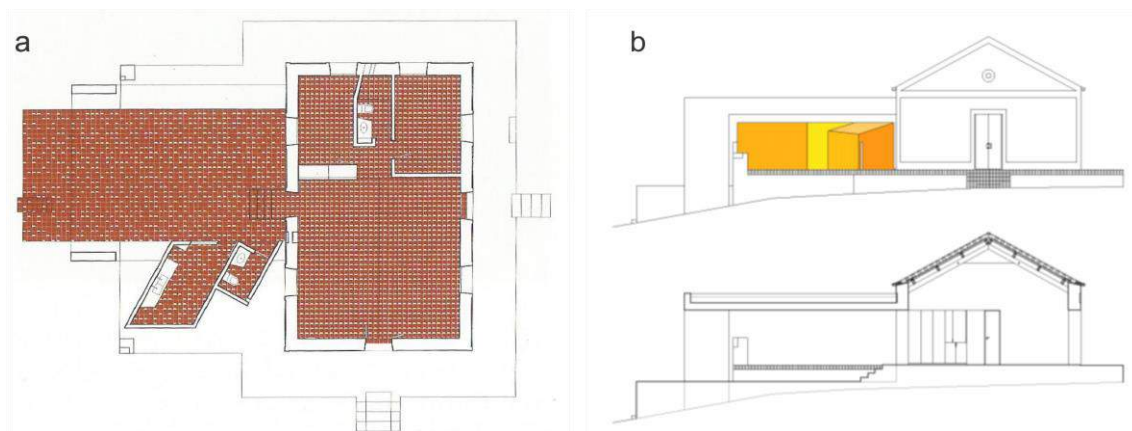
Planta de piso, vista e corte da casa-grande do Engenho Queira-Deus
